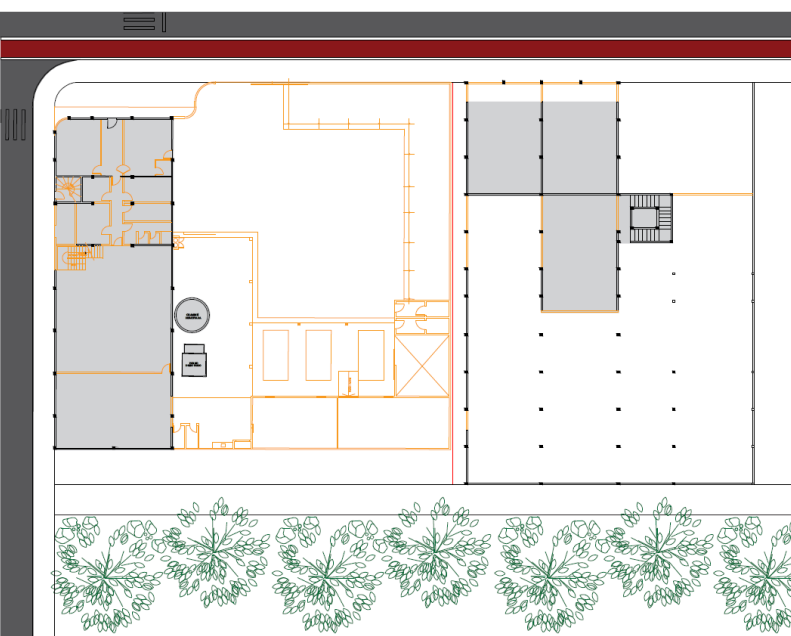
Planta baixa reforma | 1º Pavimento - Situação atual
